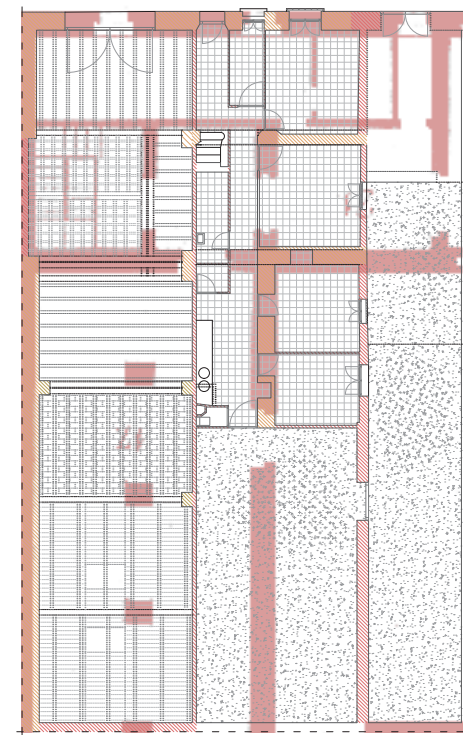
Plano de planta baja según estado actual (Fuente: elaboración propia). Superposición con Plano de 1805 del Intendente Delgado
